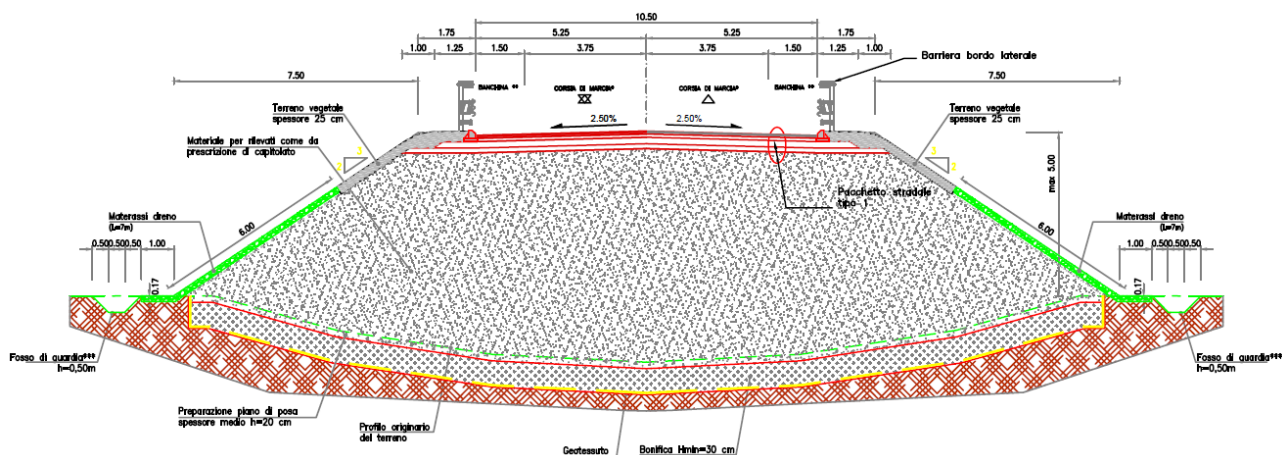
Sezione tipo del rilevato e protezione di 7m con materassi Reno su geotessuto
